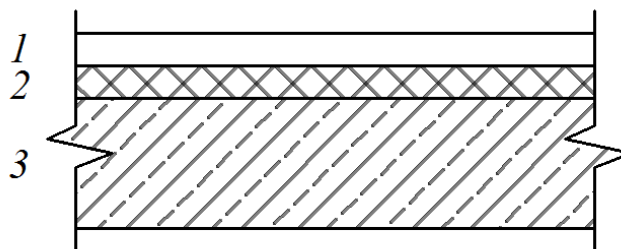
Конструкция покрытия. 1 – стяжка, 2 – утеплитель, 3 – железобетон
